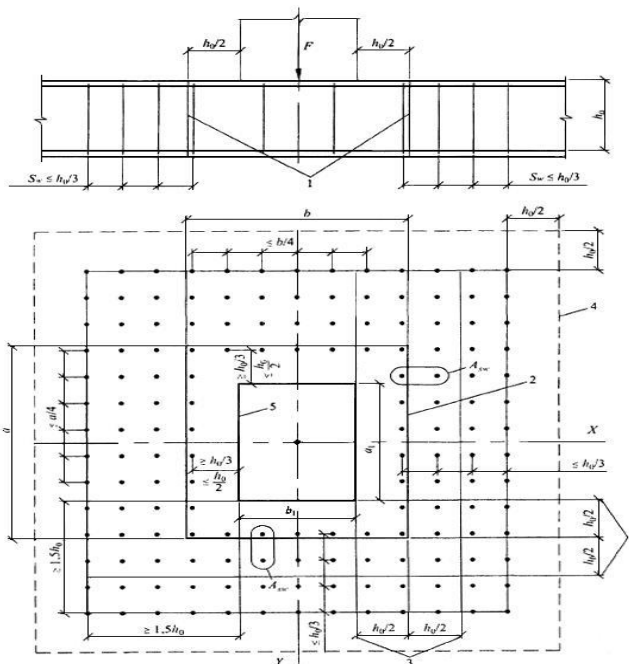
Схема для расчета ж/б плит с вертикальной равномерно распределенной поперечной арматурой на продавливание
